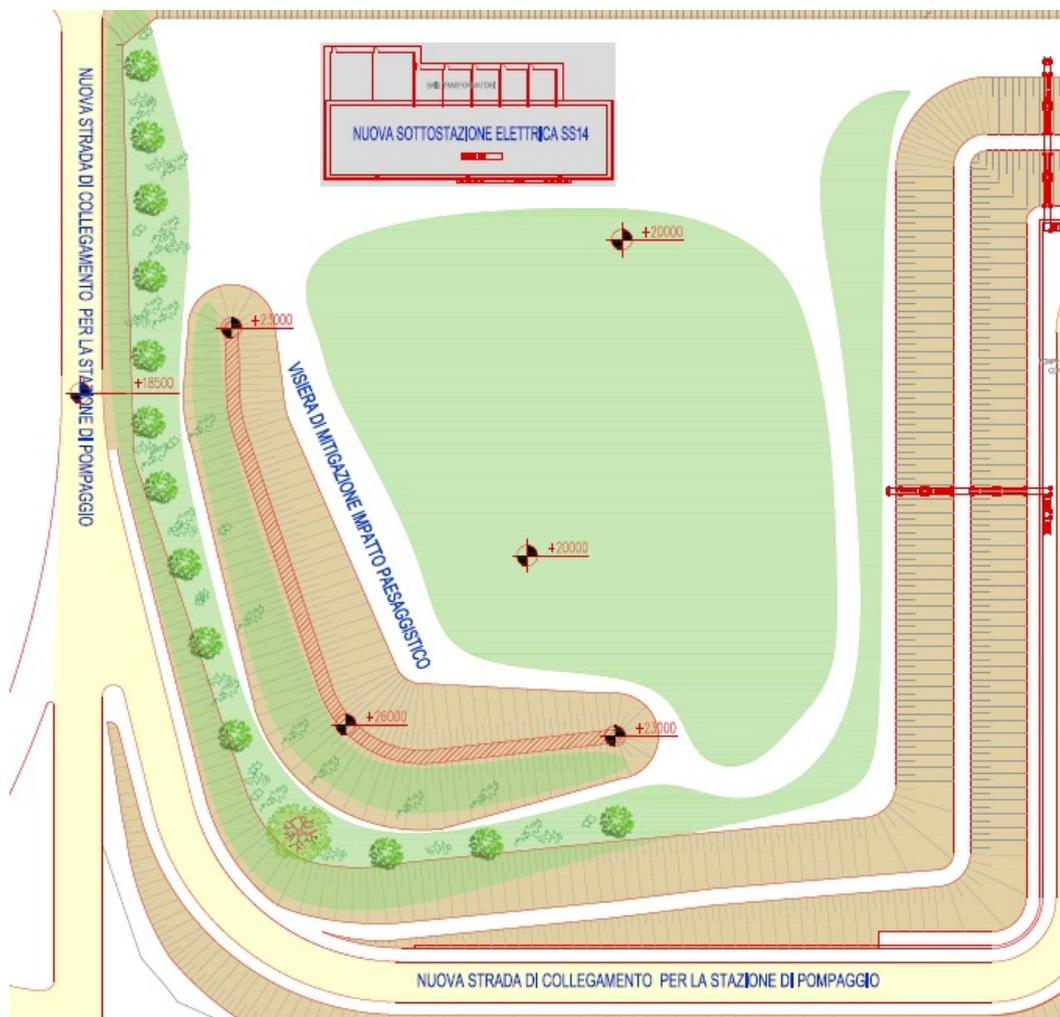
Planimetria Area Utilities – Stralcio Tav. TR-ONS-E-P-DW-028-R03
